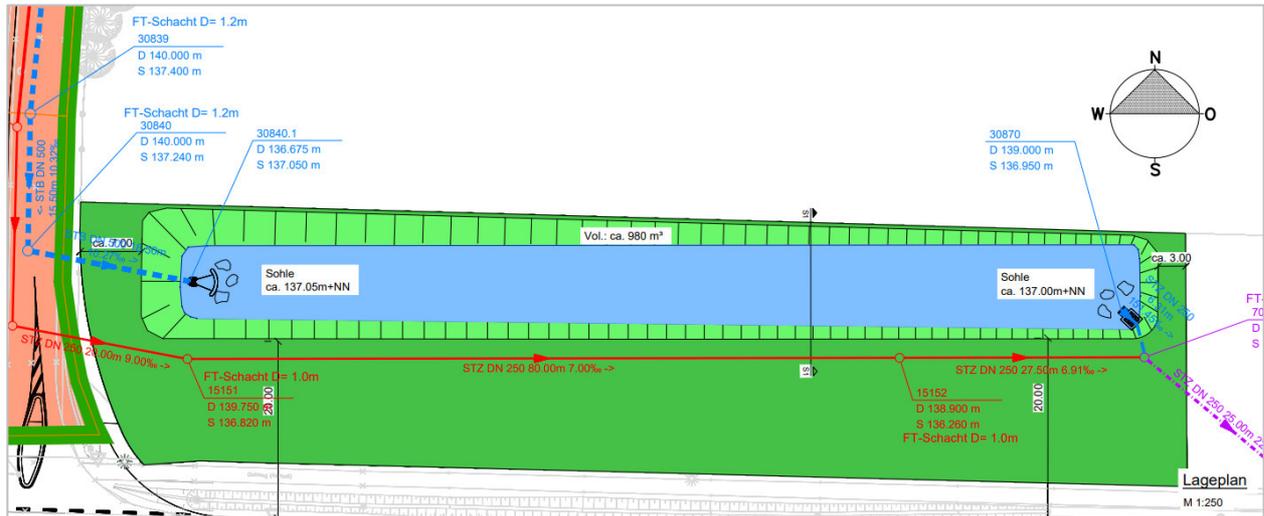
Detailplanung RRB 2 (Best Ingenieure GmbH, Anlage 310.2 Erläuterungsbericht)
